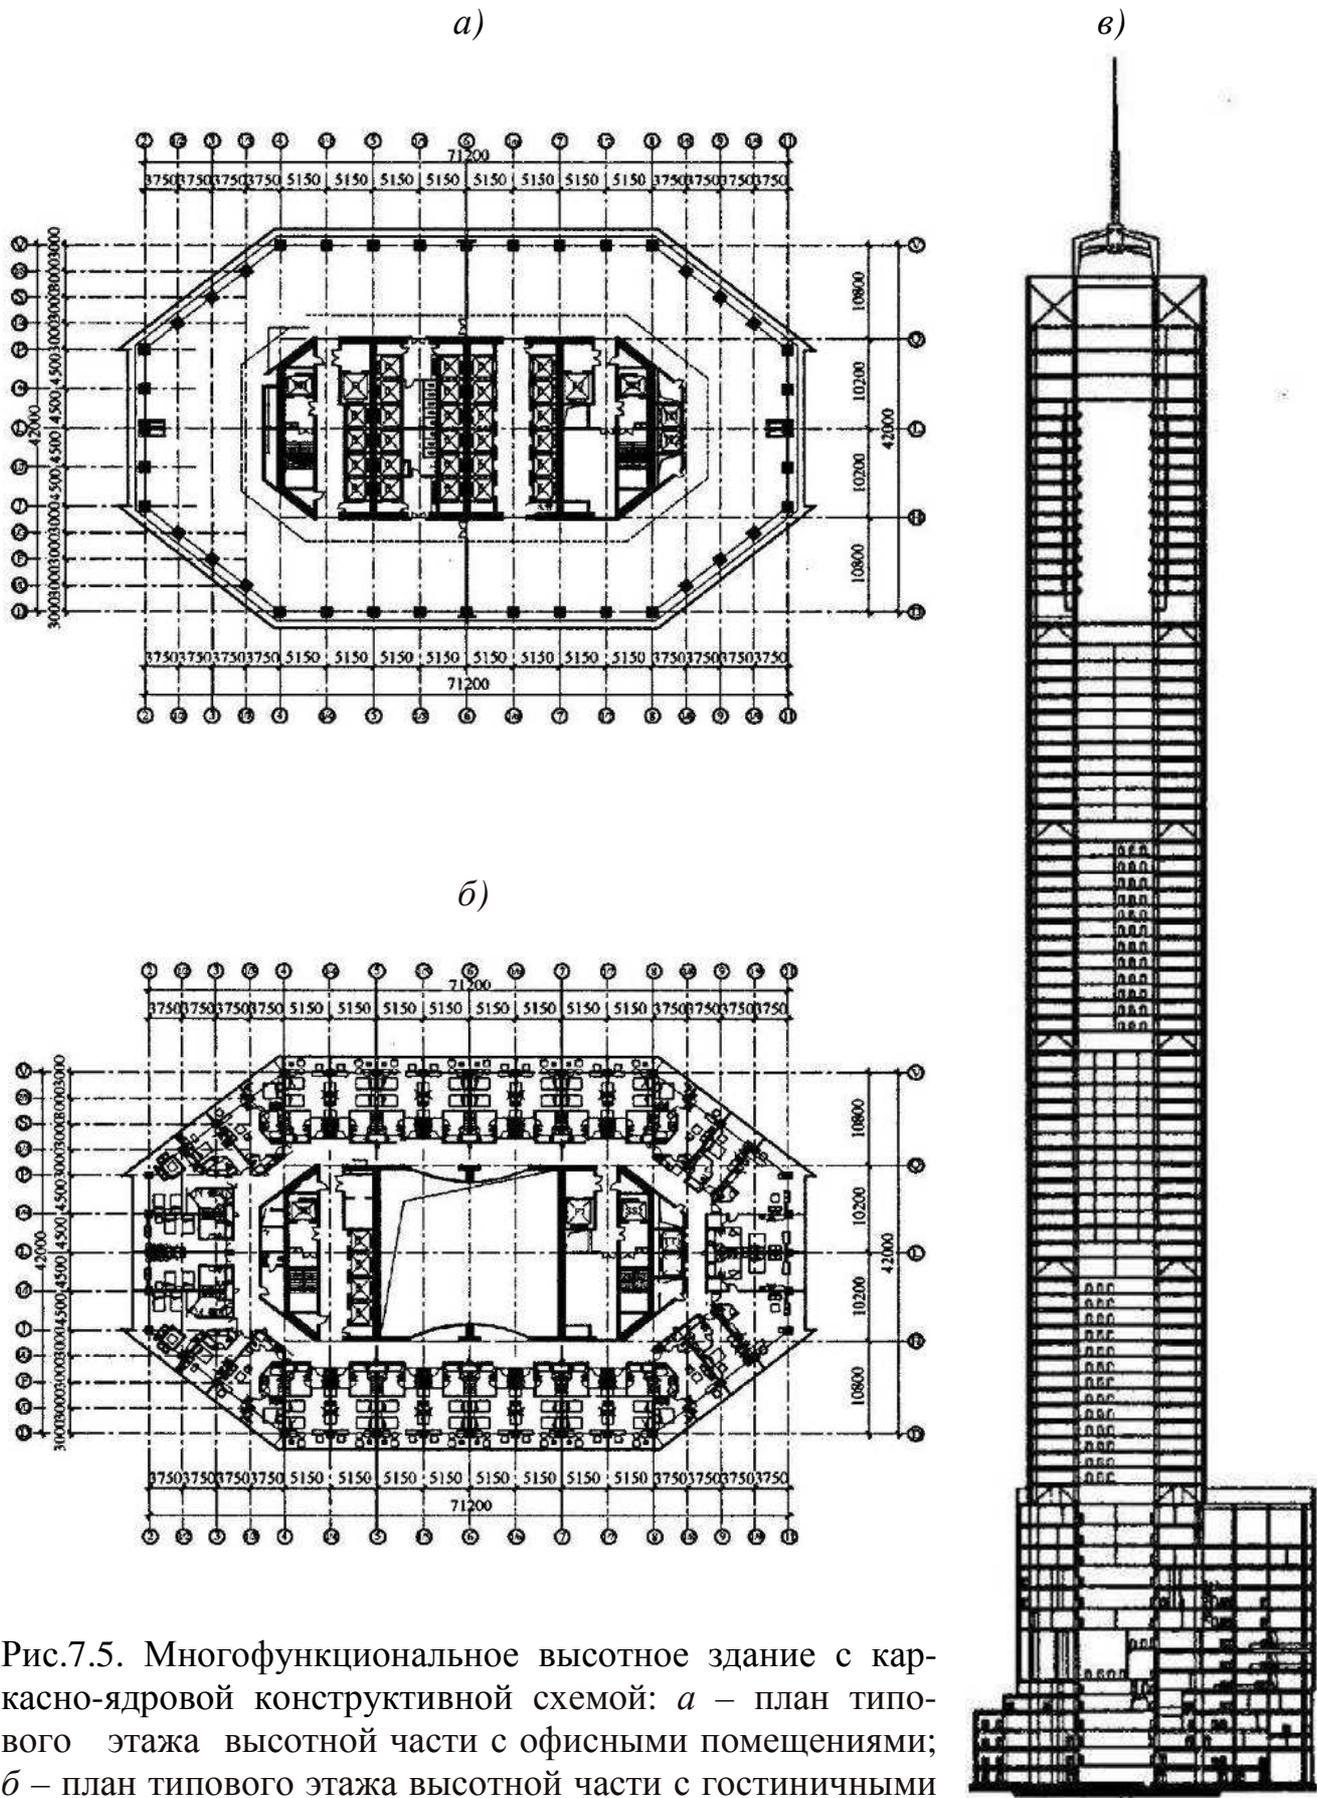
Многофункциональное высотное здание с каркасно-ядровой конструктивной схемой: а – план типового этажа высотной части с офисными помещениями; б – план типового этажа высотной части с гостиничными номерами; в – поперечный разрез
